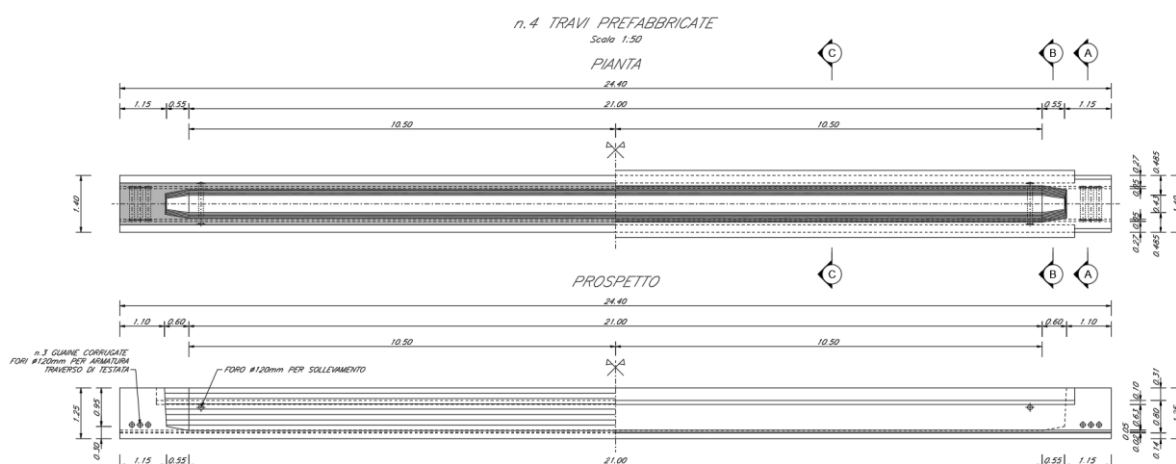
Piante e prospetto della trave prefabbricata in cap
